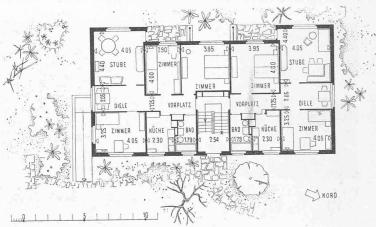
(Westseite) und Bild 4 (Grundrisse 1:300) der dreigeschossigen
